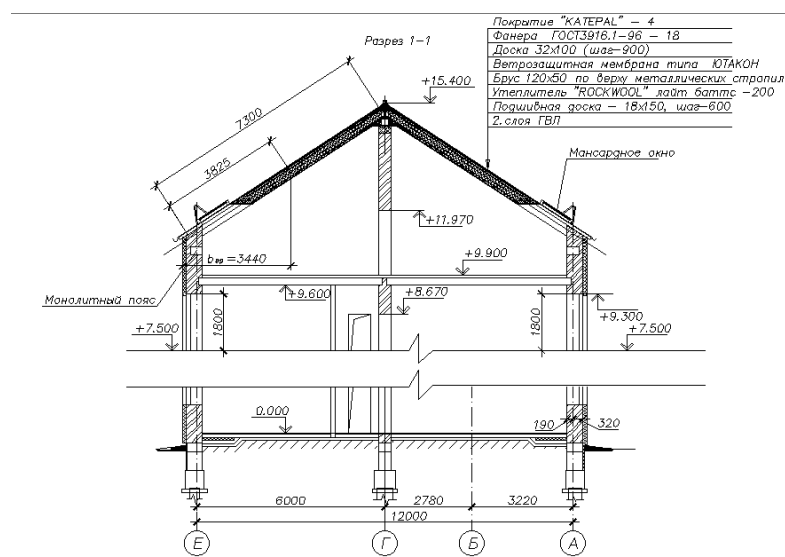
Поперечный разрез здания для сбора нагрузок с покрытия
